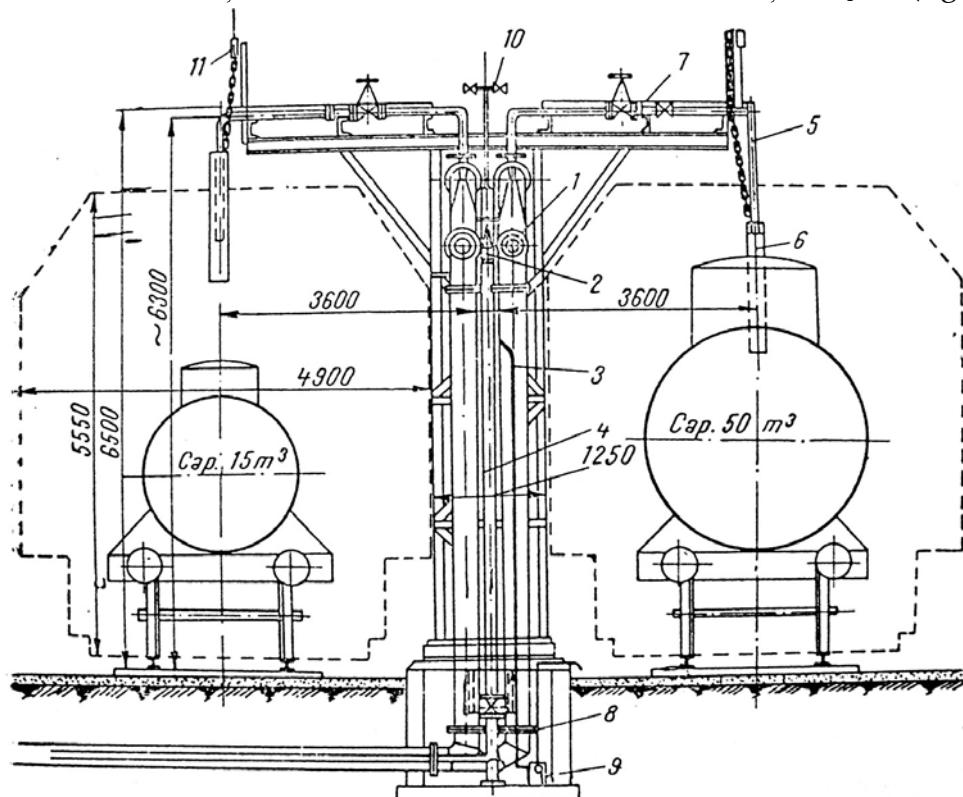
Secțiune transversală printr-o rampă de beton pentru încărcarea în vagoane cisternă a petrolului
